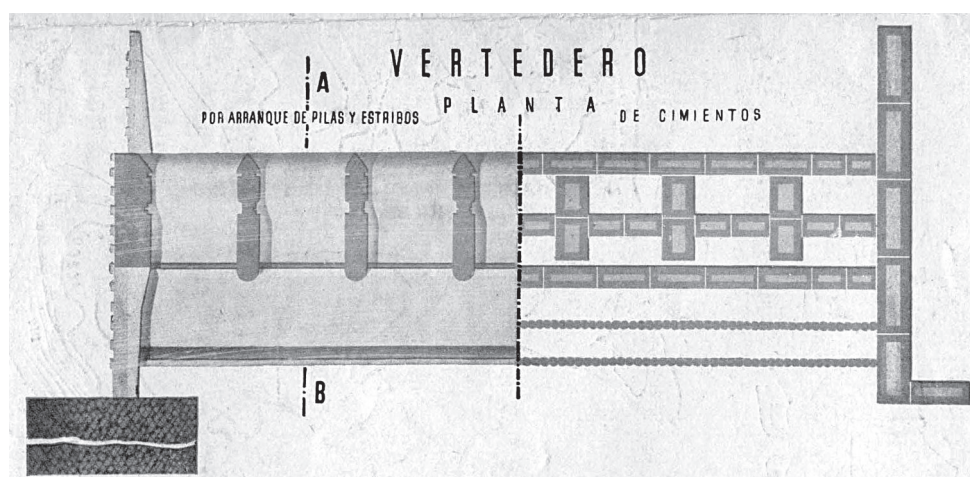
Croquis de la planta del vertedero de aguas de las compuertas de la presa y de su cimentación.
